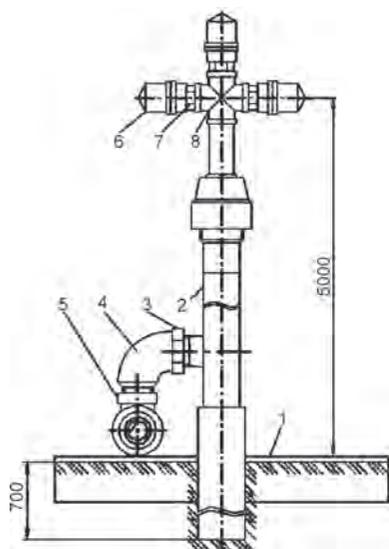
Дождеватель: 1 – основание (анкер); 2 – трубчатый стояк; 3 – контргайка; 4 – угольник; 5 – тройник; 6 – насадка; 7 – ниппель; 8 – крестовина
